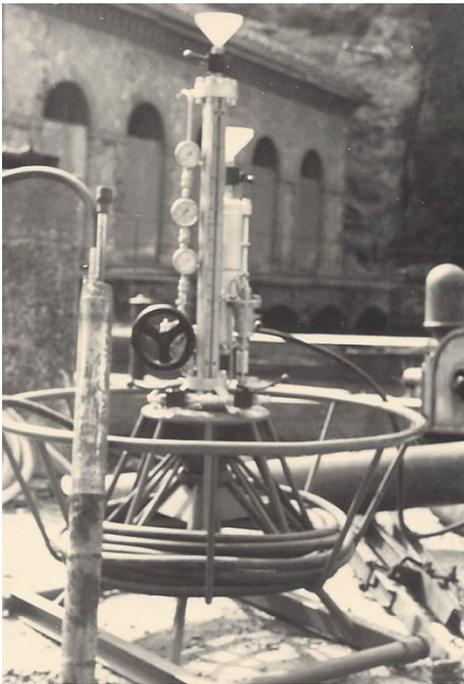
Il pressimetro da roccia Rodio (cantiere Trezzo Sull'Adda, 1960).
